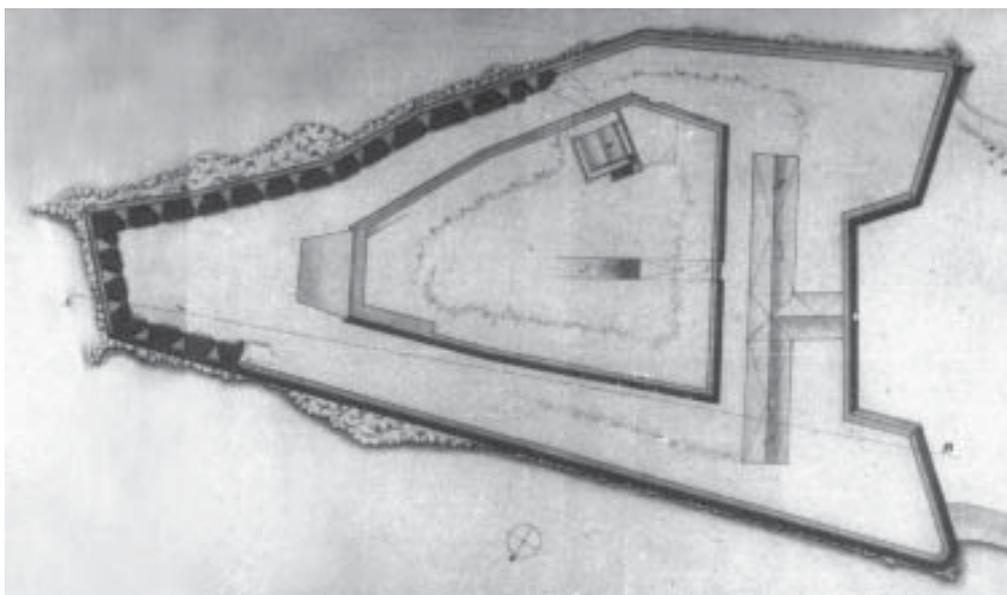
Planta da parte superior do Forte de Villegagnon – Jacques Funck, 1781
